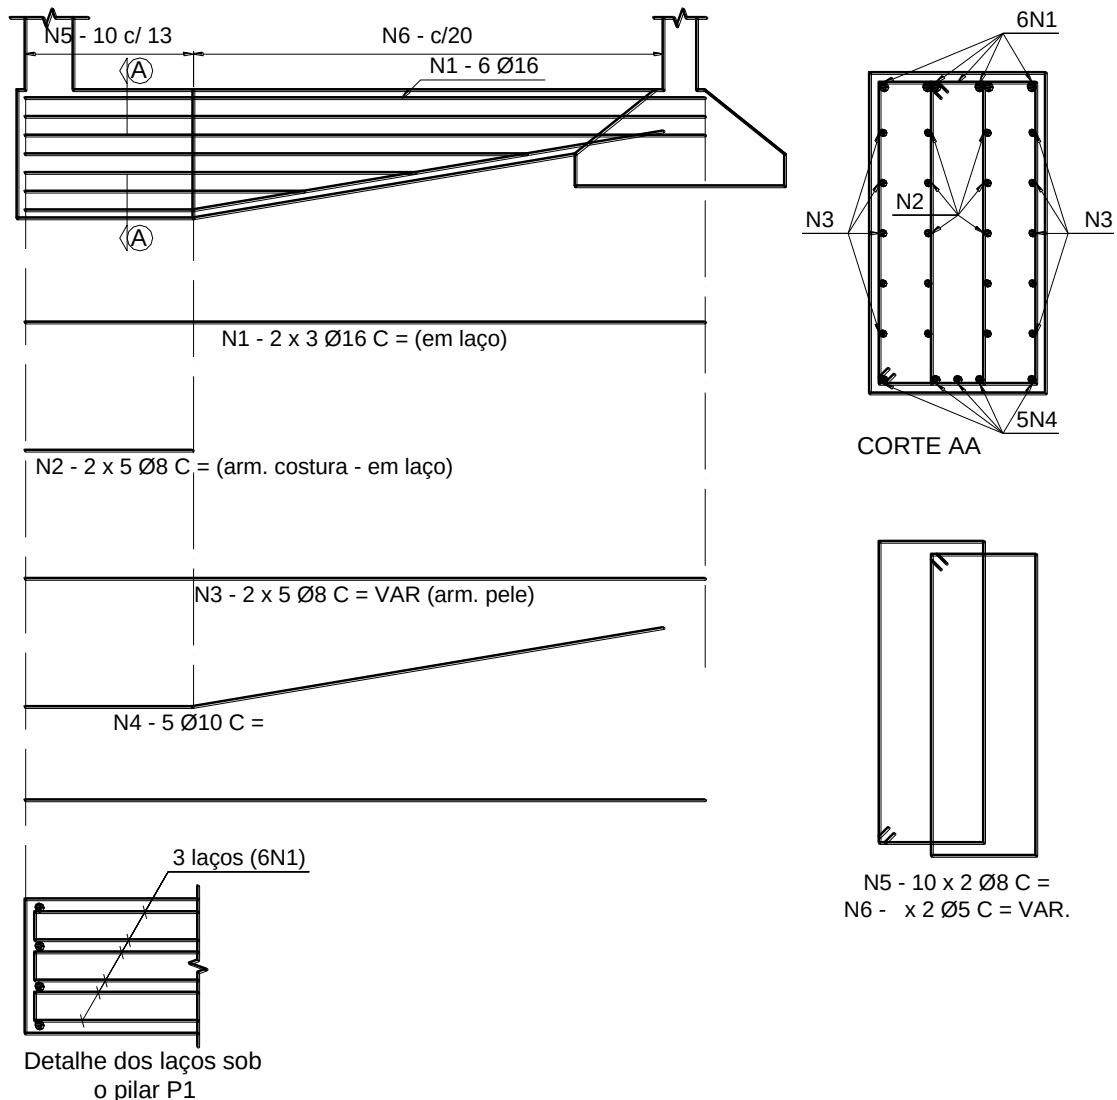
Detalhamento das armaduras na viga de equilíbrio (viga alavanca).
